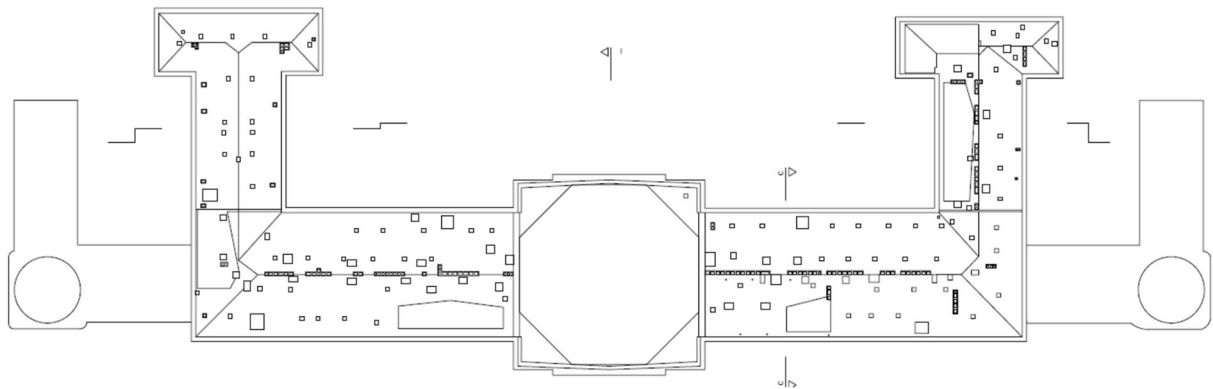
Grundriss Dachgeschoss und Dachaufsicht
